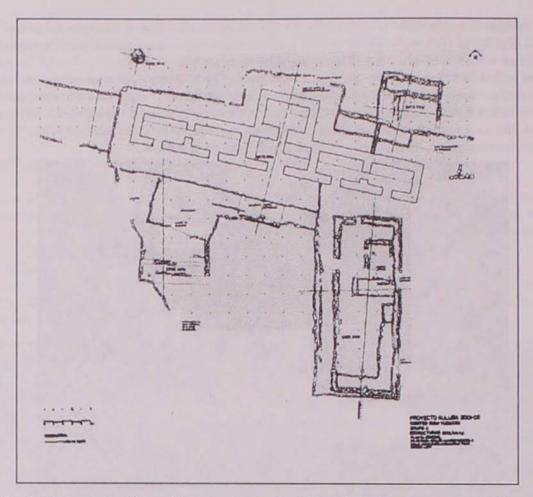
Planta arquitectónica del conjunto arquitectónico de la plaza noroeste del Grupo A.
